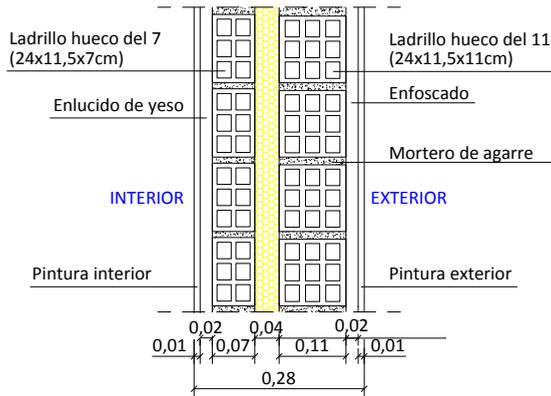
Detalle constructivo del nuevo cerramiento 3 de la vivienda en su estado reformado.
